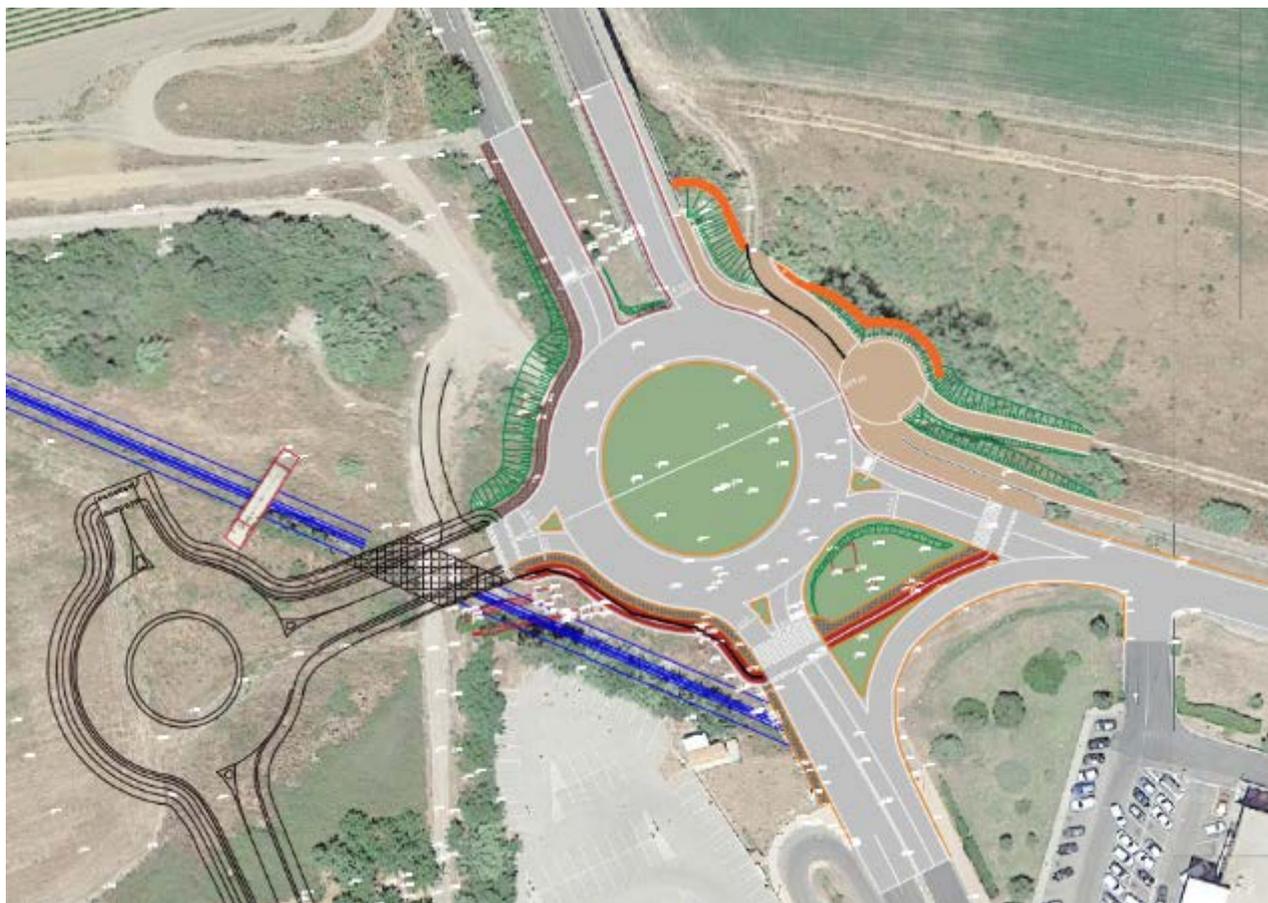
Planimetria di progetto (in nero parte non oggetto di appalto)
